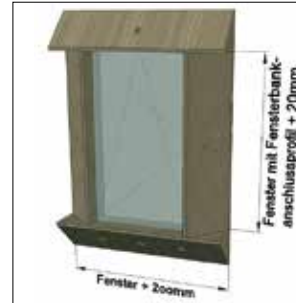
Maße Zuschnitt Zarge für 10-mm-Fuge
